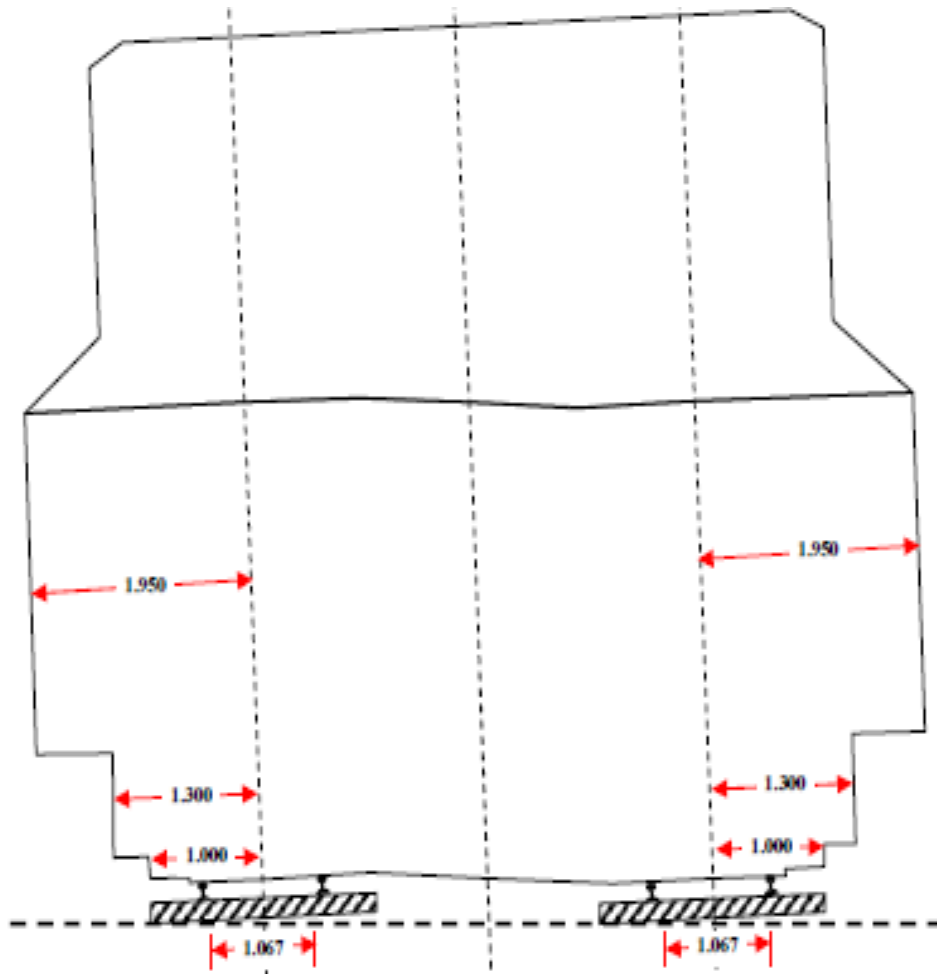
Ruang Bebas Pada Daerah Tikungan
